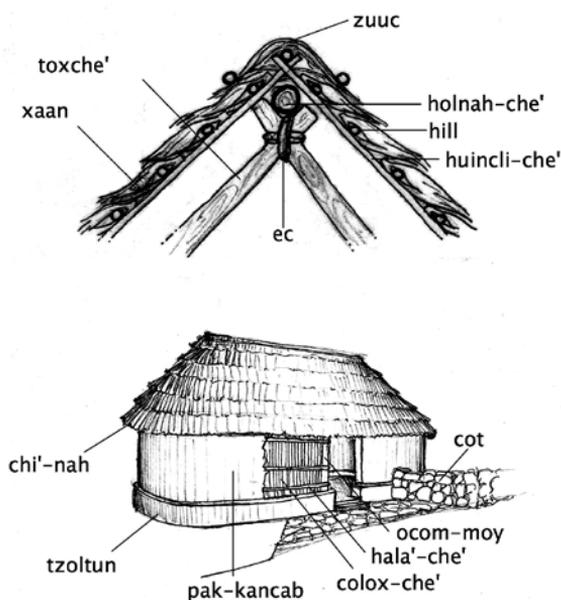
Proceso de construcción de la cubierta, muros y acabados de la vivienda
